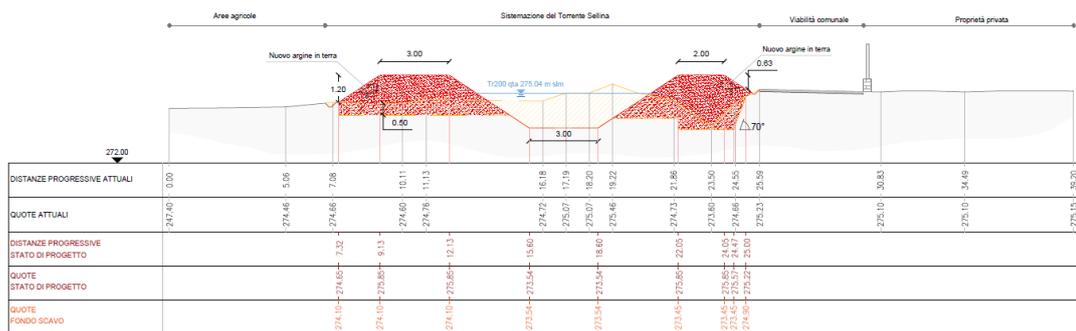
estratto della tavola T03b del progetto - Sezione 2305.52
